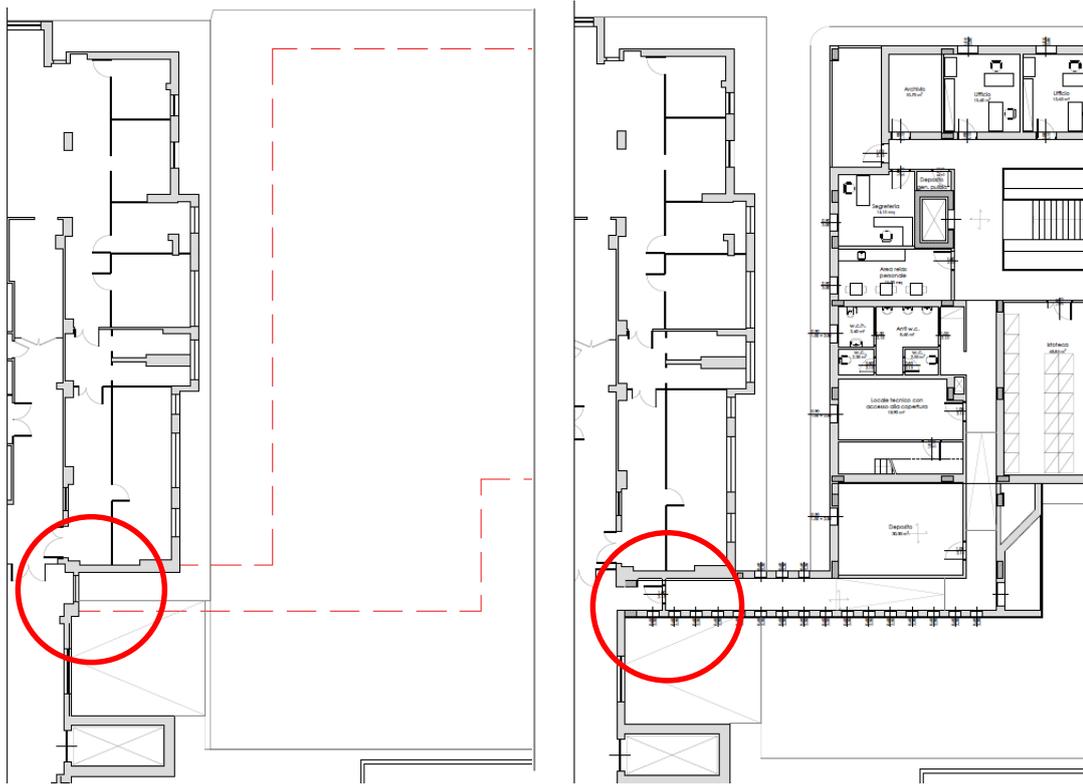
Stato di fatto e progetto porzione edificio "A" con indicazione della modifica prevista
